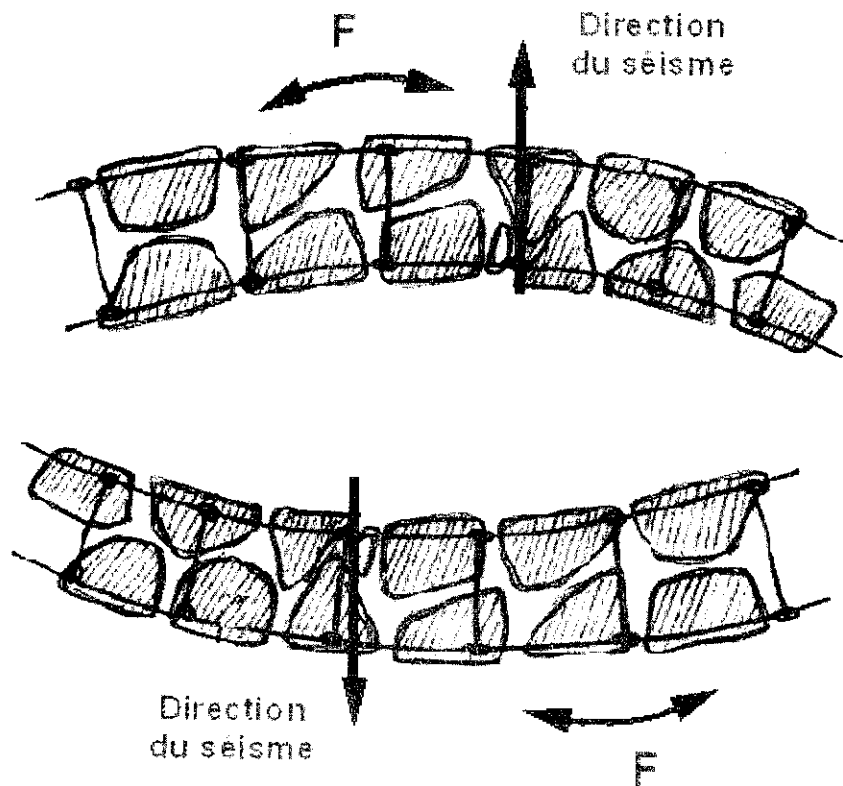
Renforcement horizontal par grillage métallique en fils galvanisés
